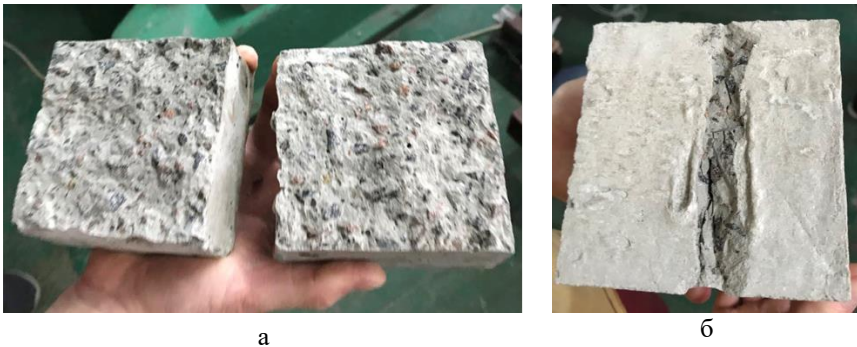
Вид зразків після випробувань на розколювання: а – бетонний; б - фібробетонний
